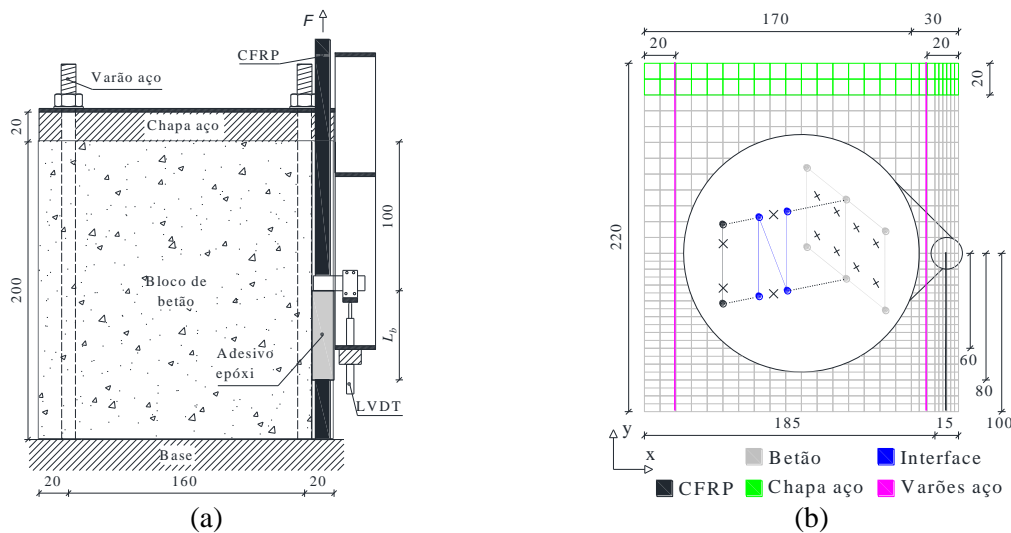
Ensaios de arranque direto: (a) geometria e configuração de ensaio; (b) malha de elementos finitos adotada. Nota: as dimensões são em milímetros.
